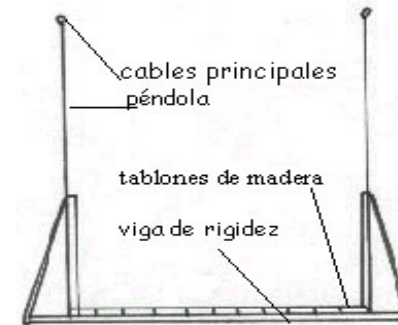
Sección transversal típico. Ingrid Raventós (2000).
